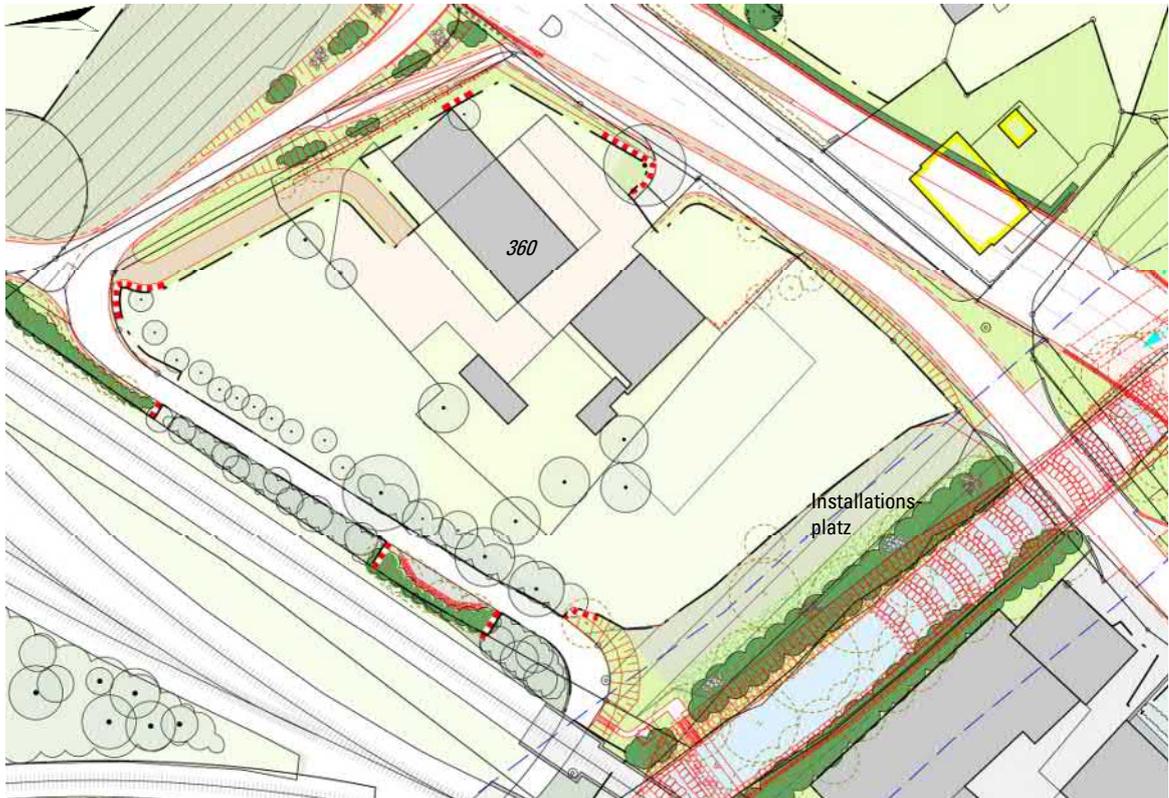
Planausschnitt: Unterführung Stockmatte bis Wyna, Seite West
